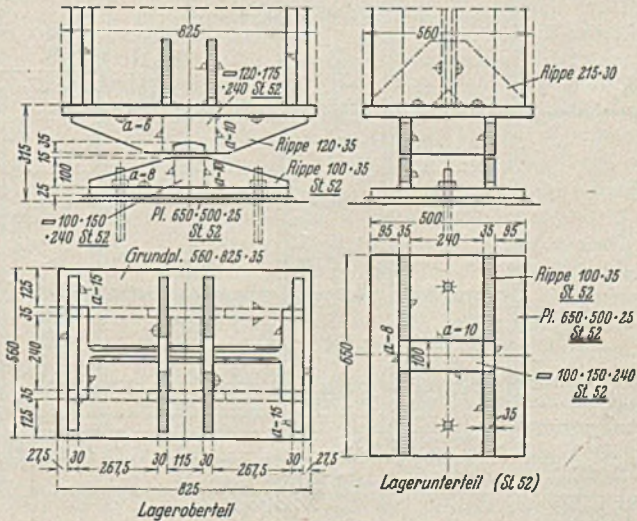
Lager der Hauptbinder (aus St 52 zusammengeschweißt).
